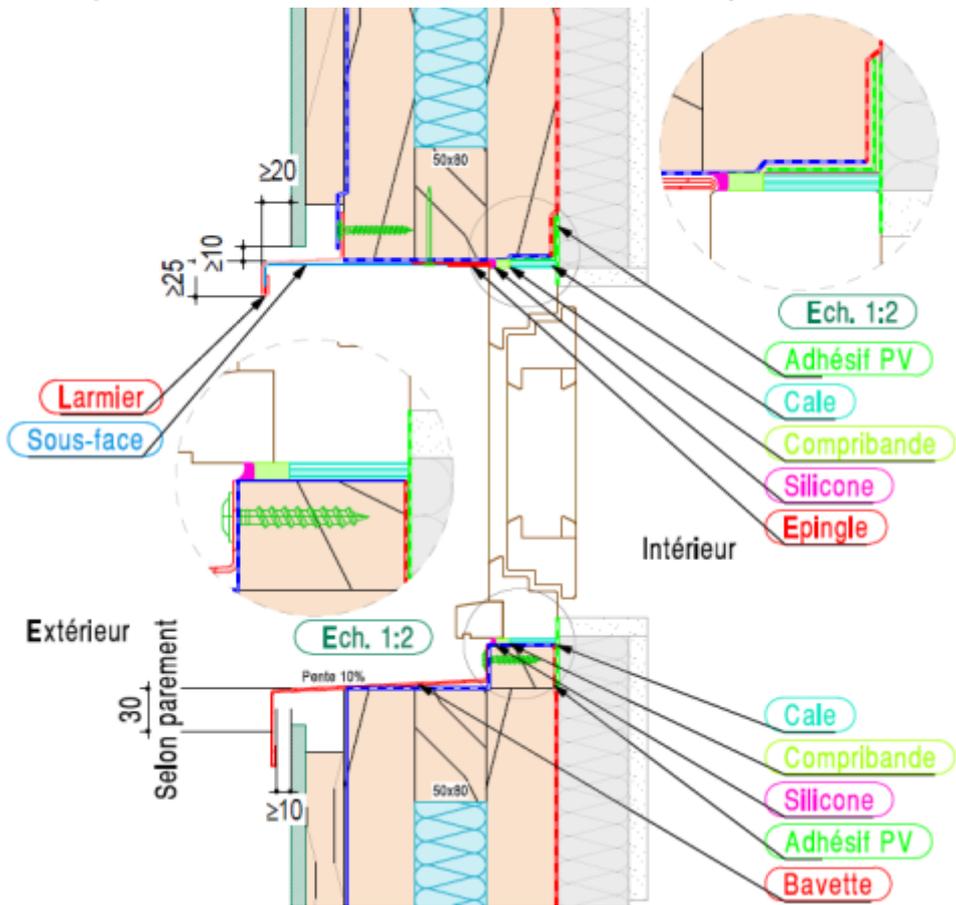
Menuiserie en tunnel au nu intérieur / Coupe verticale
